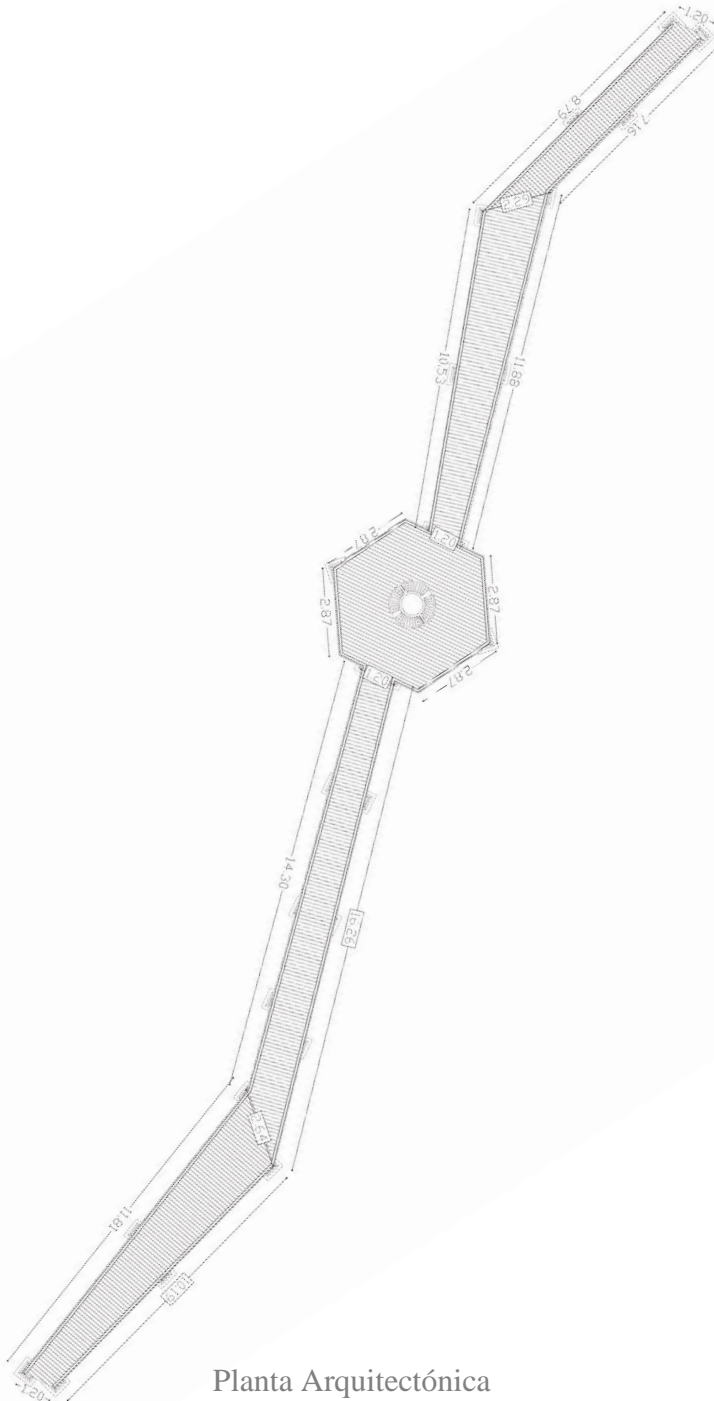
Planta arquitectónica de mirador 5. Fuente: grupo de investigación.
